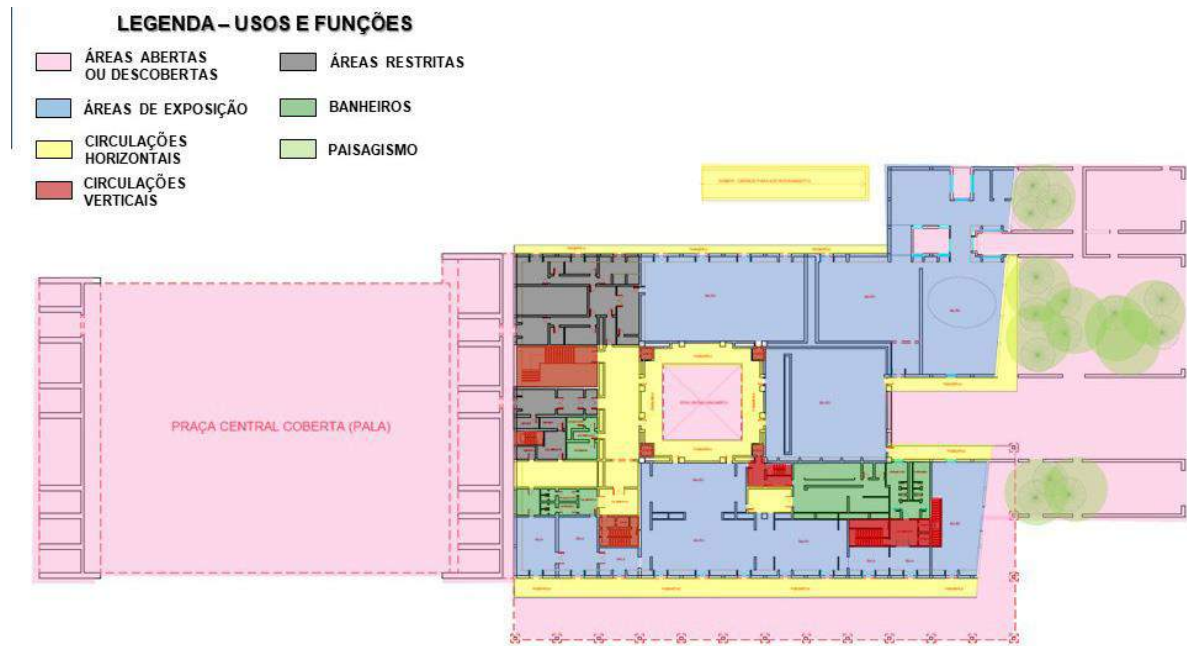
Planta do pavimento térreo do Pavilhão de Portugal, com seus usos e funções
